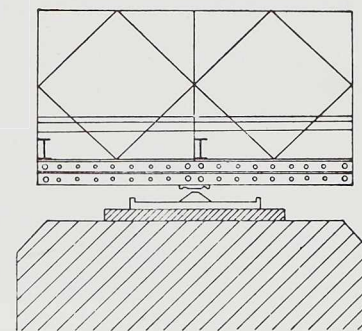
et 666. Dispositif d'appui sur culée et sur pile.
